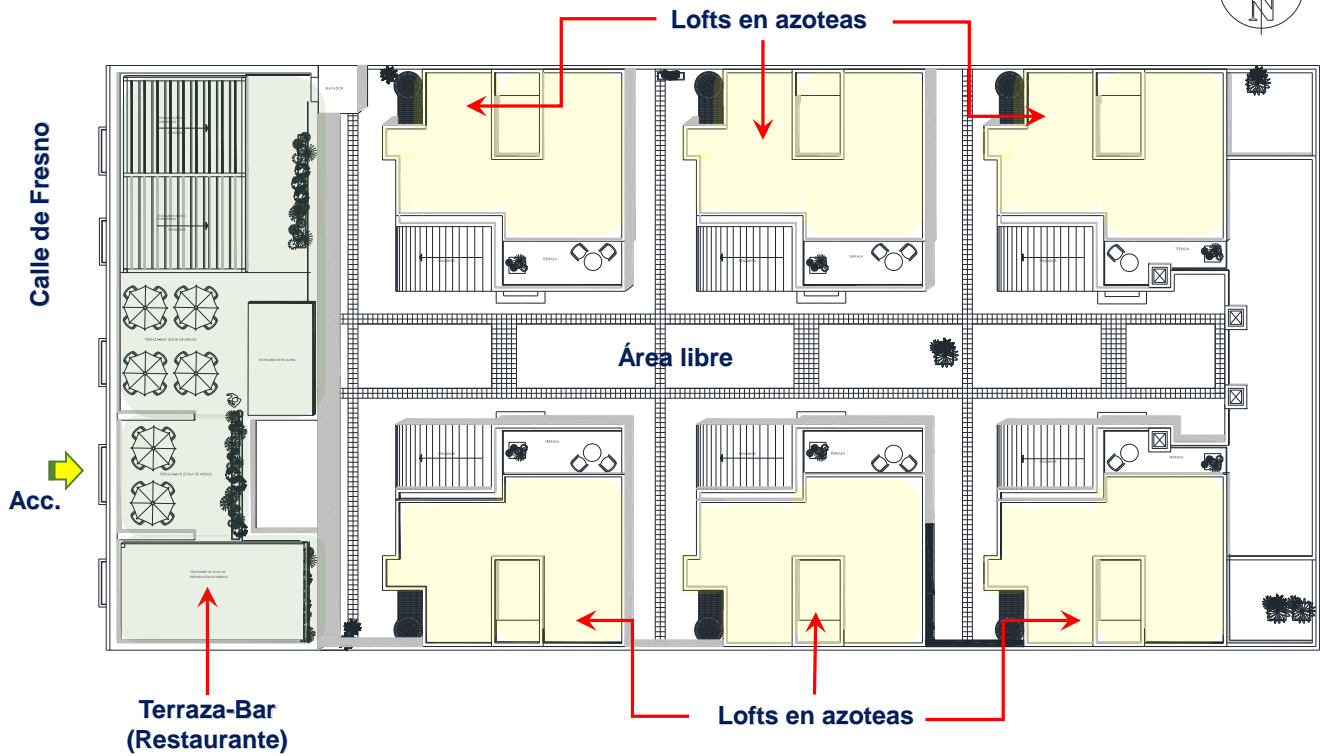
y 121. Planta de conjunto con la nueva propuesta y resultado de la fachada principal.
